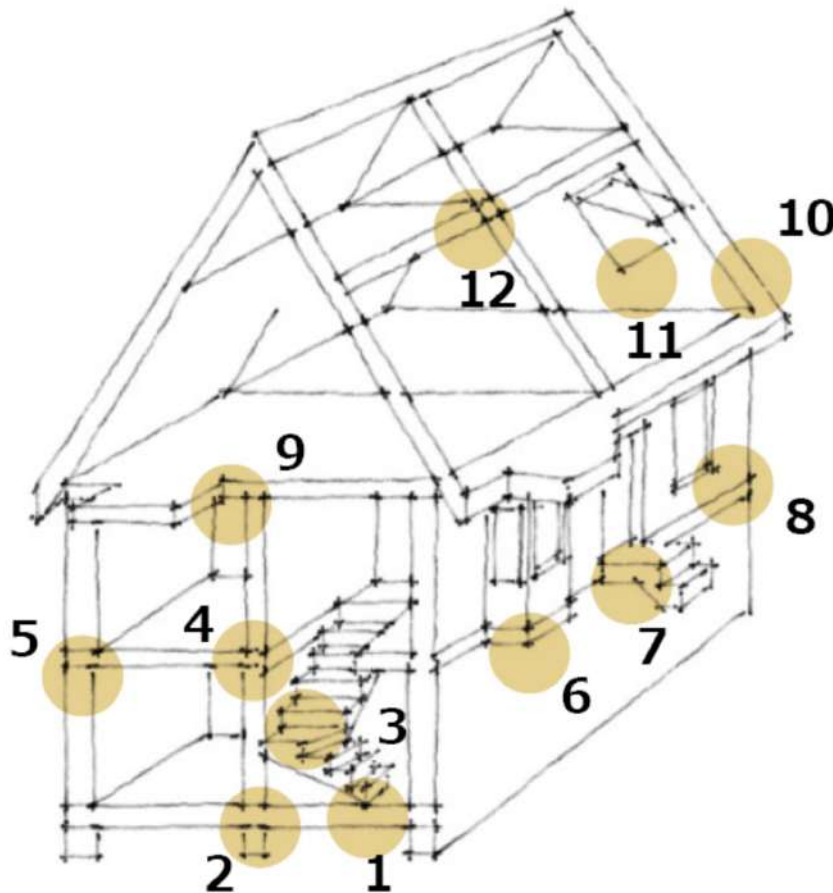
Pozicionet saktë për instalimin e izolimit termik dhe një shembull i një zgjidhjeje të shkëlqyer për daljet e konsolit
